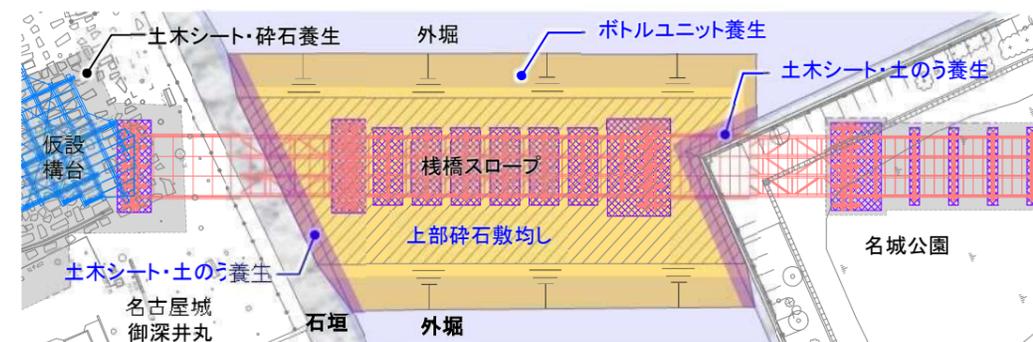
棧橋スロープとボトルユニットによる外堀保護対策(平面図)
